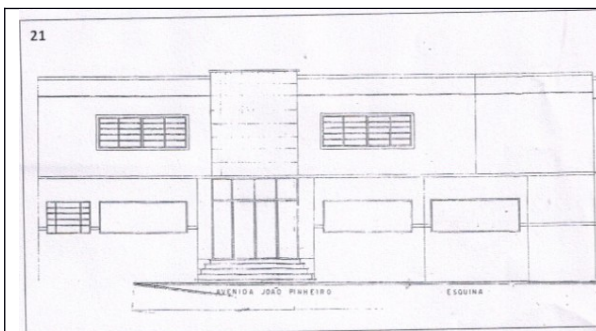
Fachada da edificação, conforme projeto aprovado.
